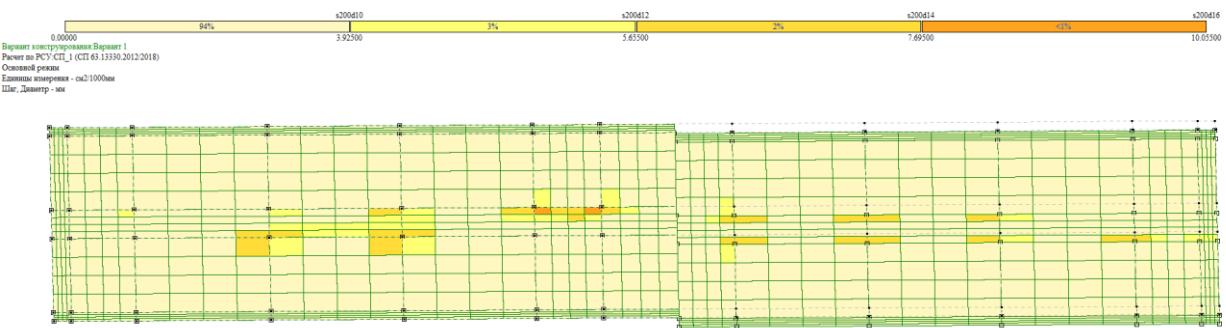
Верхнее и нижнее армирование фундаментной плиты
